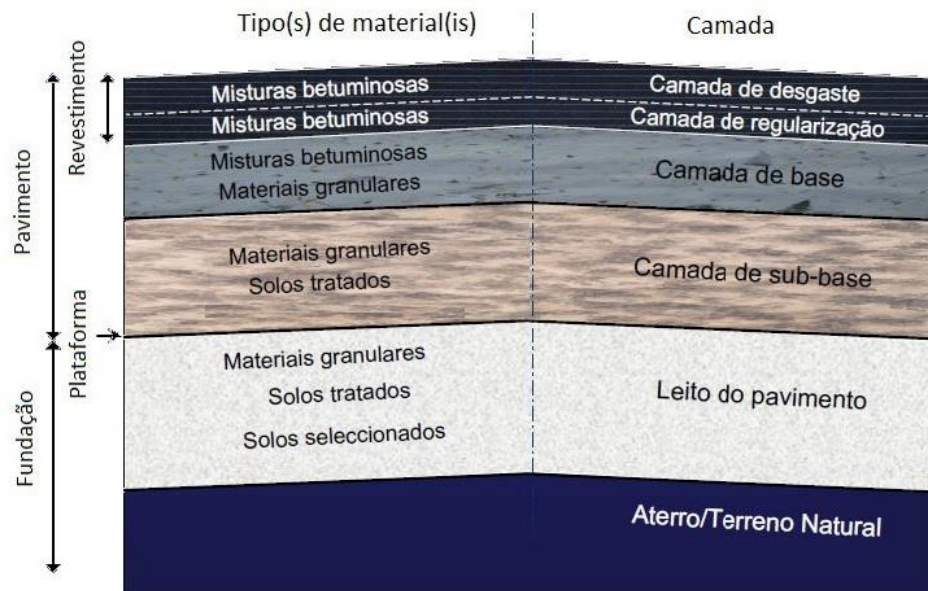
Estrutura de um pavimento flexível (adaptado de Antunes et al. 2006)
